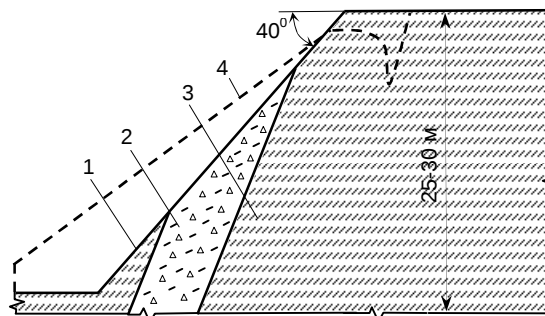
Поперечный разрез неустойчивого уступа: 1 - поверхность строения нерабочего уступа с транспортной бермой; 2 - зона дробленых пород; 3 - аргиллиты и углистые сланцы; 4 - поверхность откоса после деформирования
